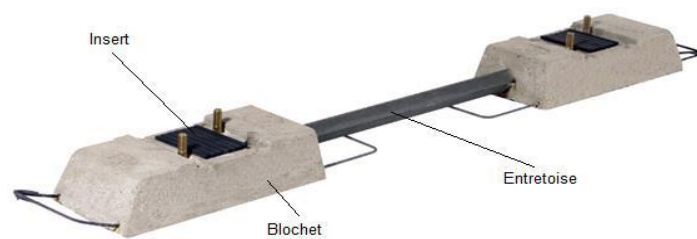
Exemple de traverse béton bi-bloc [18]
